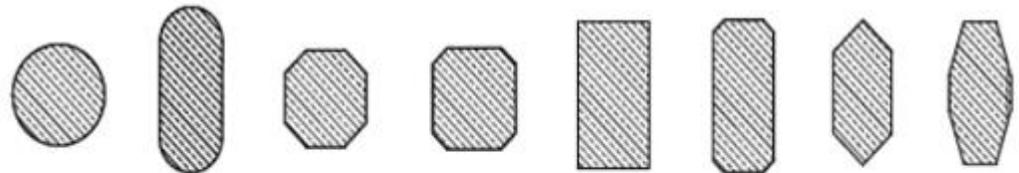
Algunos tipos de sección transversal de columnas en puentes
